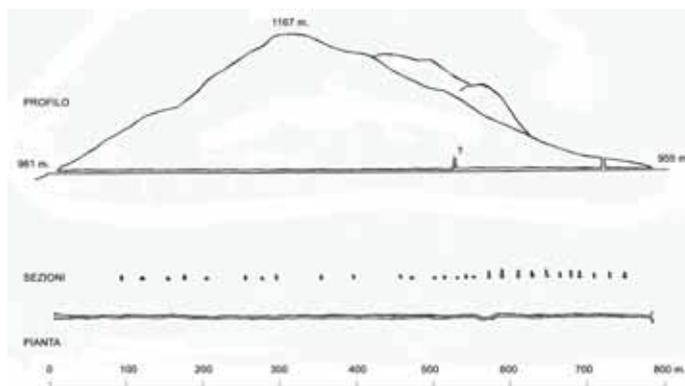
Profilo planimetrico del cunicolo di monte Frontino
